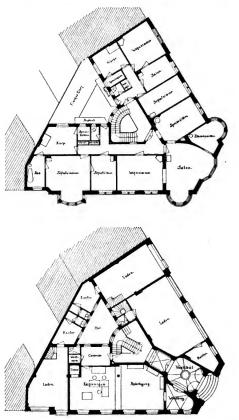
u. 387. Sparkasse vor dem Steinthor. Grundrifs der beiden Hauptgeschosse. H. Mänz. 1898.
